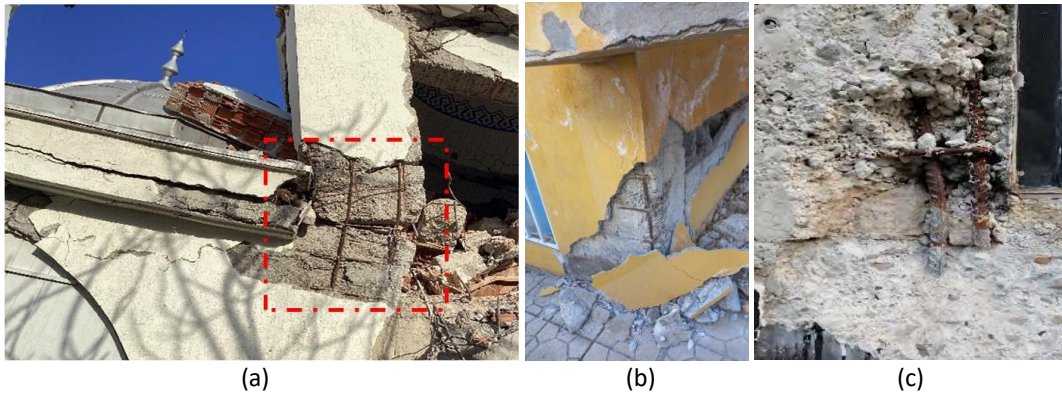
Beton-nervürlü donatı aderansının yetersizliğinden dolayı betonun donatı etrafından sıyrılması (BTÜ, 2023, s.36-37)
